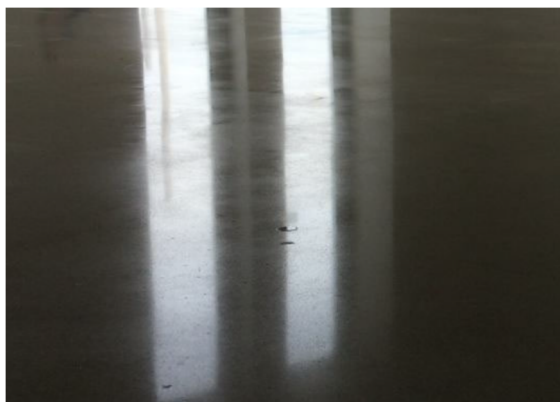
Pavimento de hormigón pulido, brillo y vista del pétreo.
